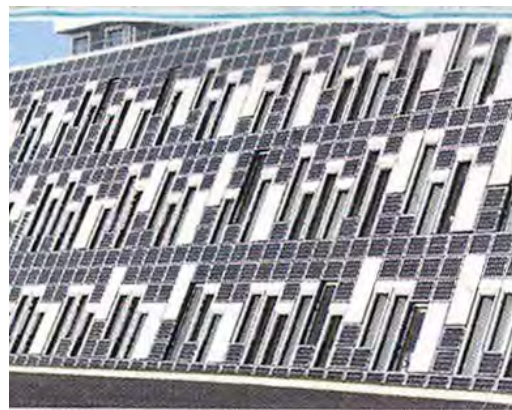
NUEVAS TÉCNICAS PARA FACHADAS LIGERAS (fachadas cortina y fachadas de vidrio) de alto desempeño e inteligentes aplicables a proyectos nuevos y de renovación
